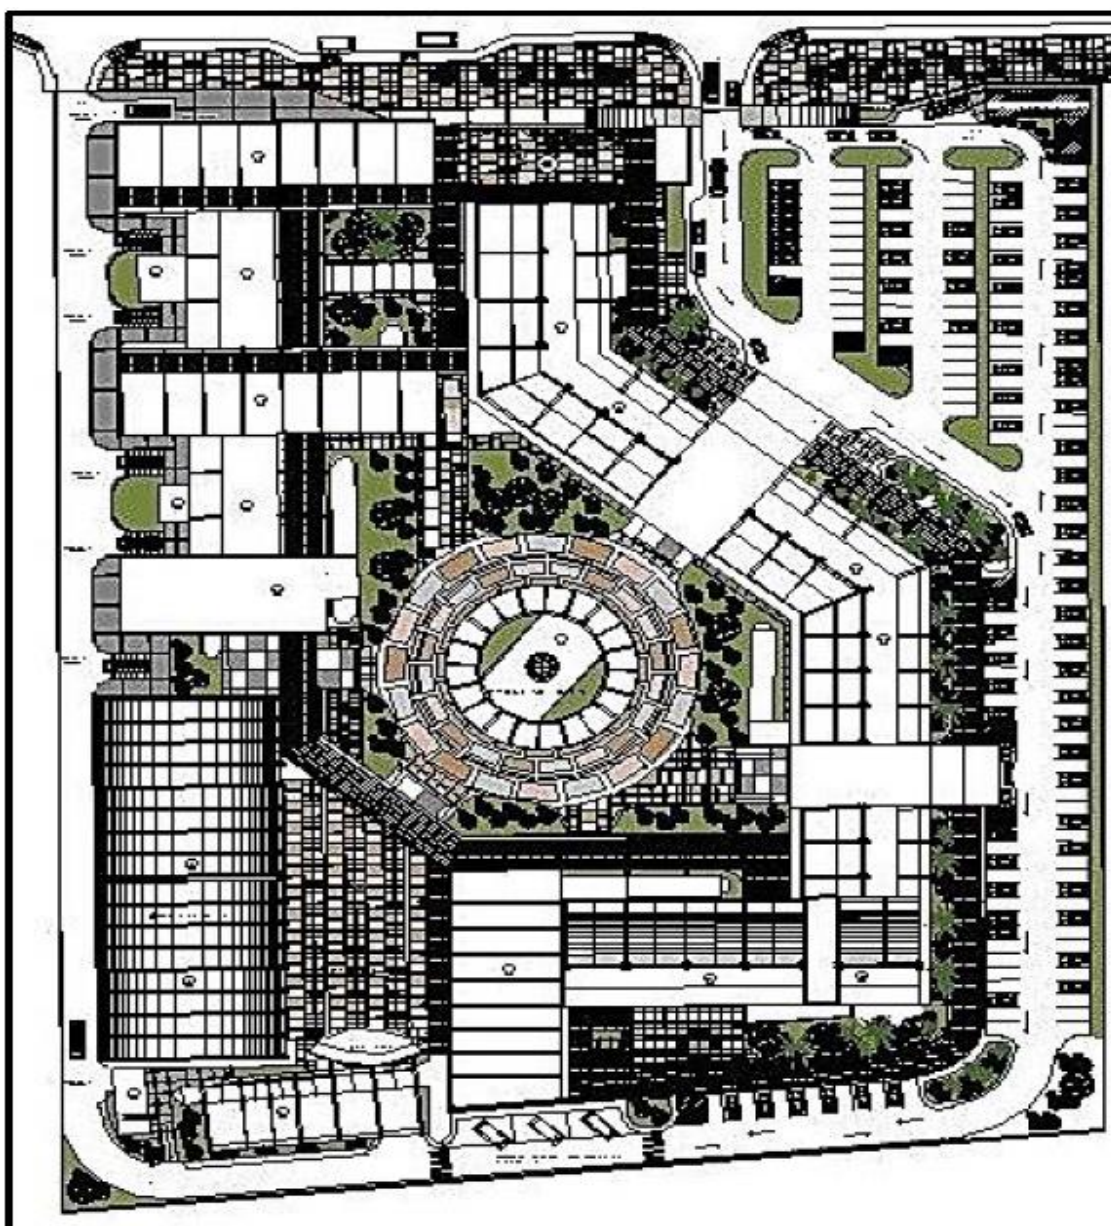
Propuesta Planta Conjunto Núcleo Armando Mendoza
